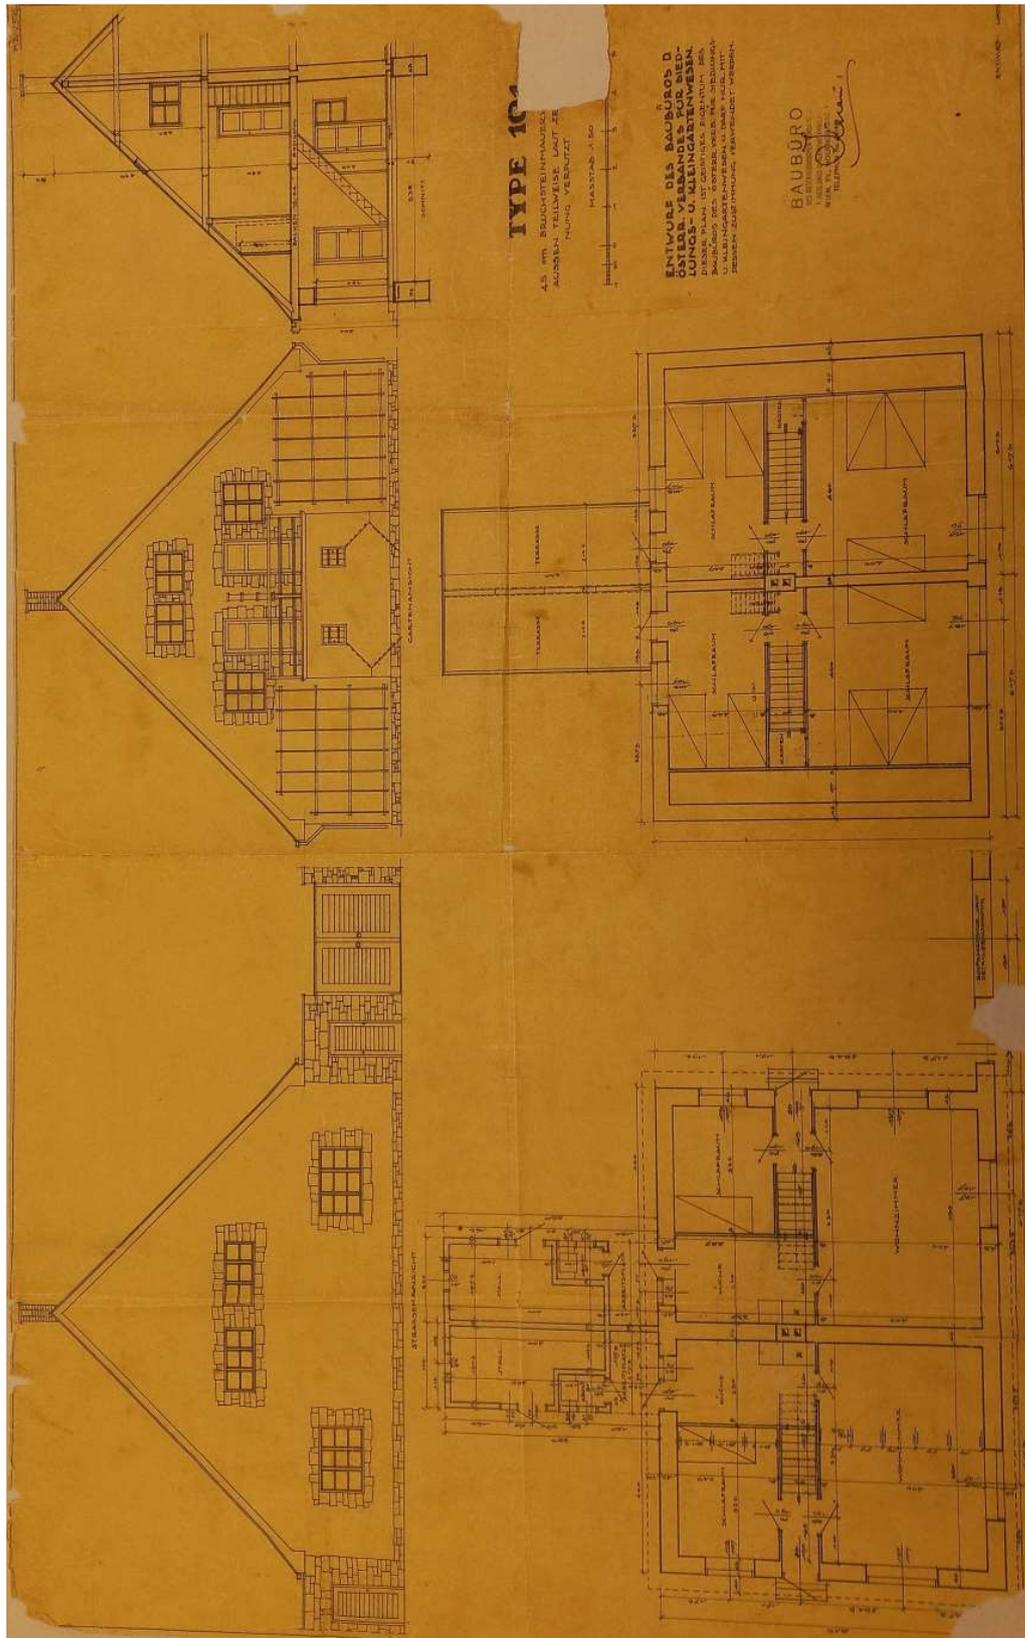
Abb.XXV:Die Type 101 (Burgener Type) Grundrisse, Ansichten und Schnitt
